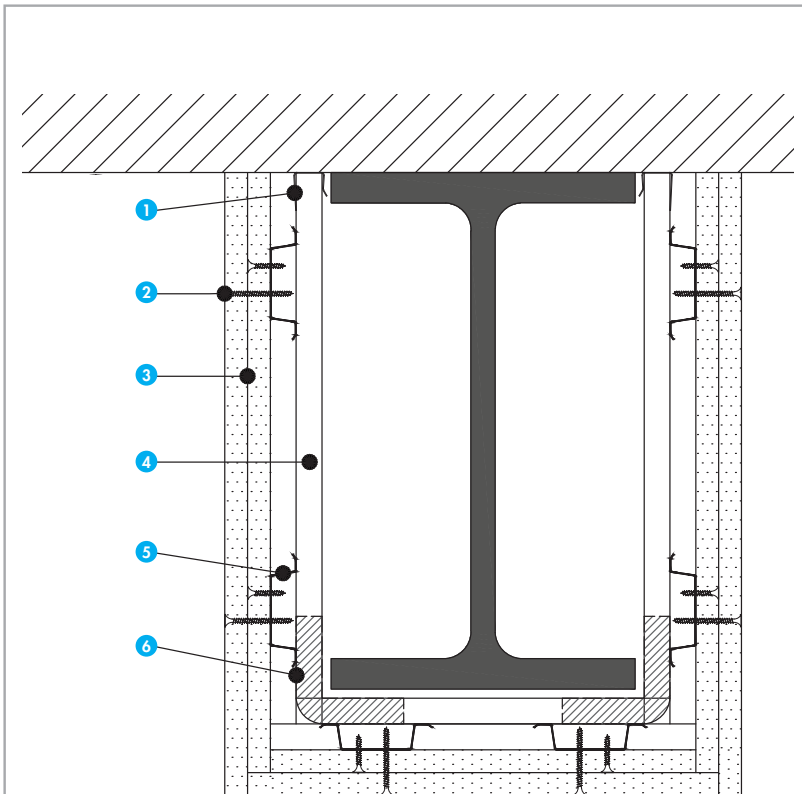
Protection des profilés avec ailes > 16 mm. Avec profilés CD60
